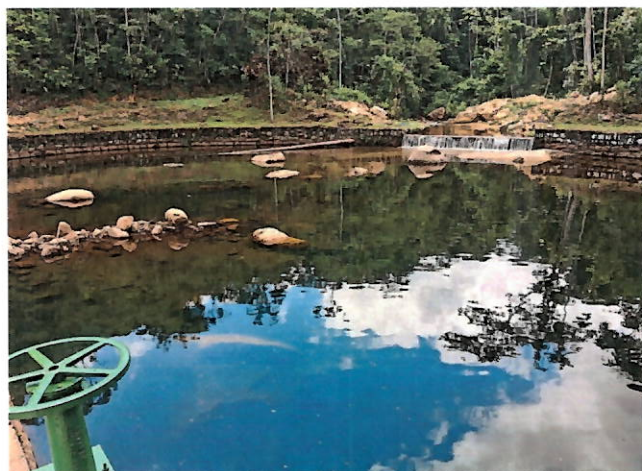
Poço com acúmulo de sedimentos e matações na área central.
